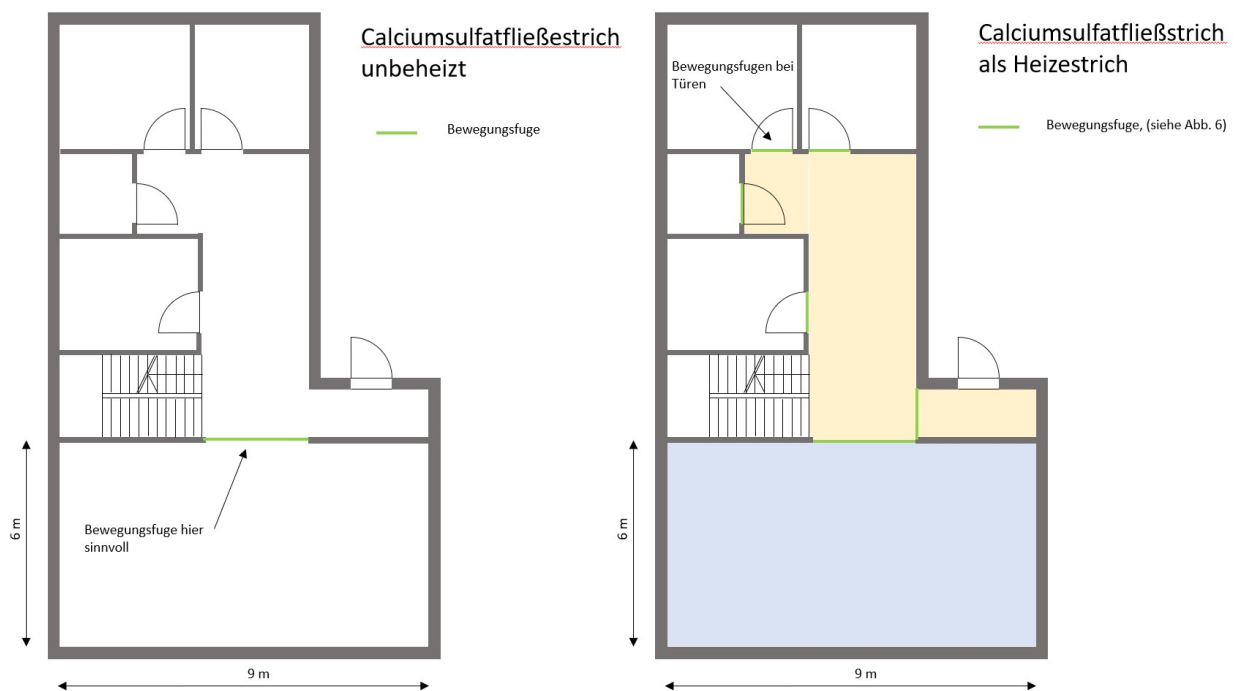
Grundriss Wohneschoß mit Calciumsulfatfließestrich (beheizt und unbeheizt)
